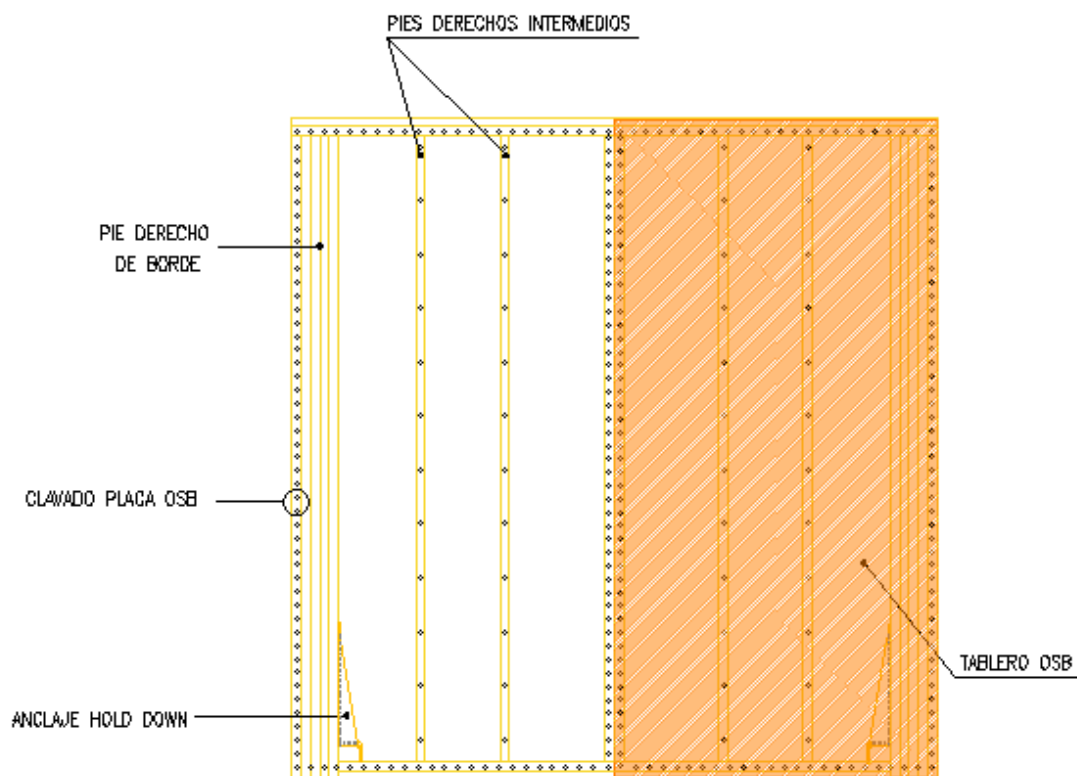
Estructuración de un muro de corte. Fuente: CIM UC.
